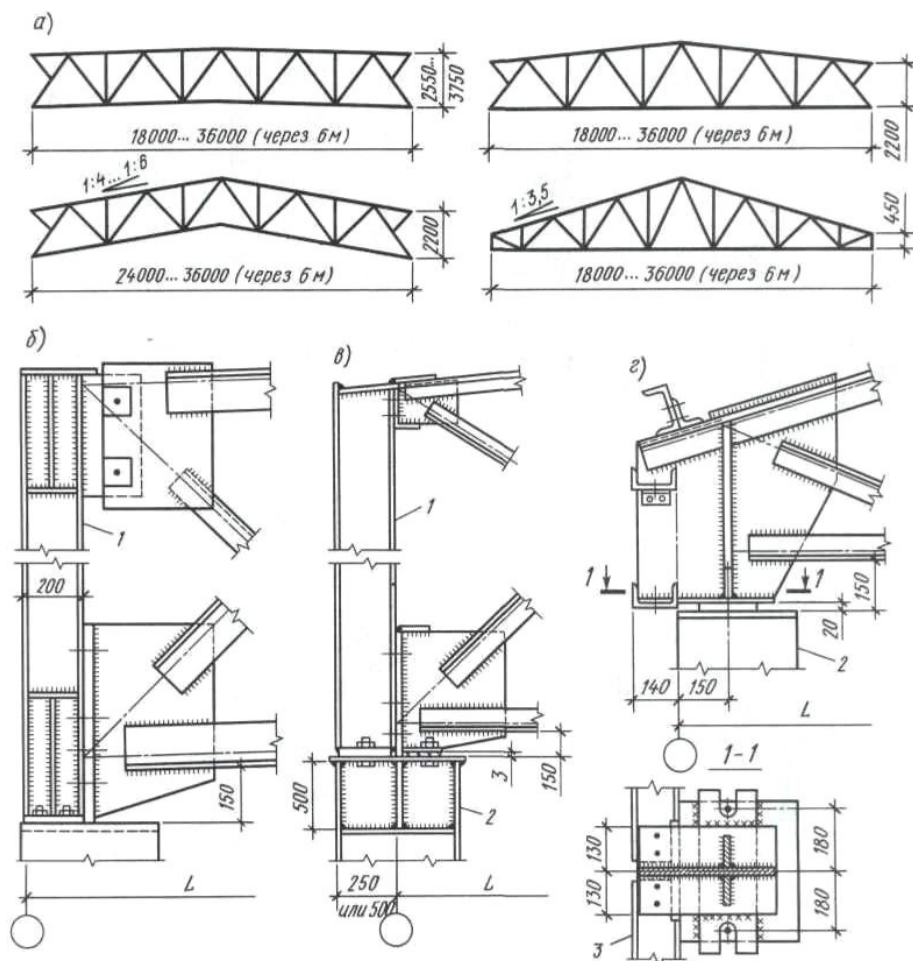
Металлические стропильные фермы пролетом 18; 24; 30 и 36 м:
